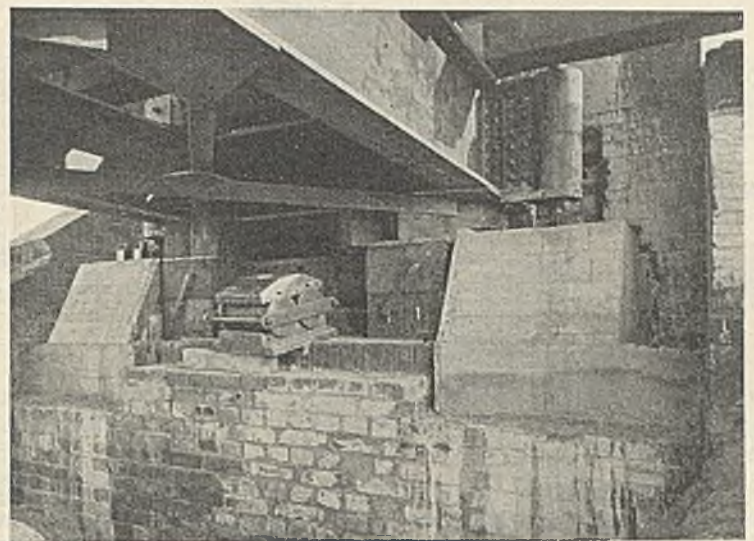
Der Schlepptäger ist abgefangen. Die neuen Auflagersteine — zunächst ohne den sie verbindenden Eisenbetonbalken — mit den neuen festen Lagern sind eingebaut. Im Vordergrund die alten Walzen mit Kopf- und Grundplatte.
